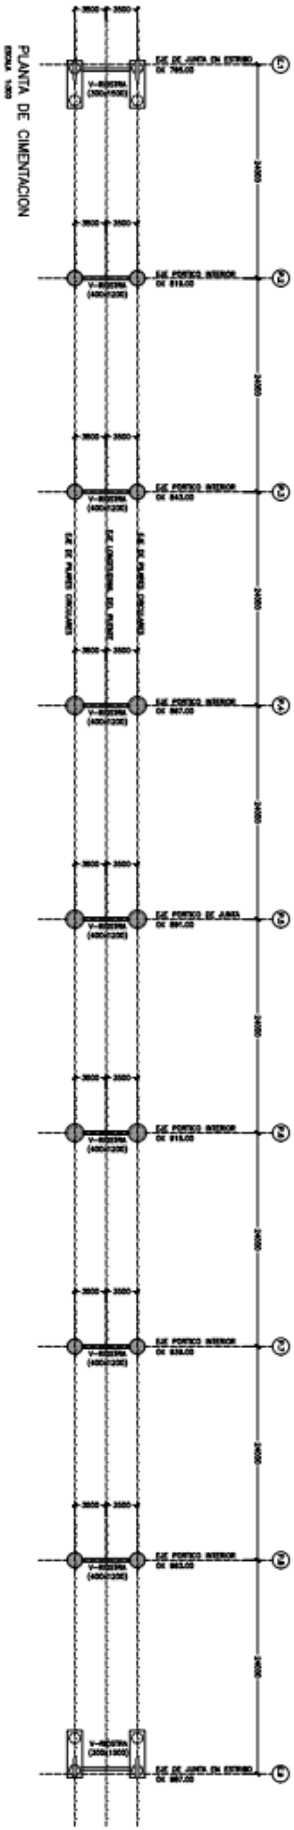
Puente sobre el río Cebollatí – planta de cimentación
